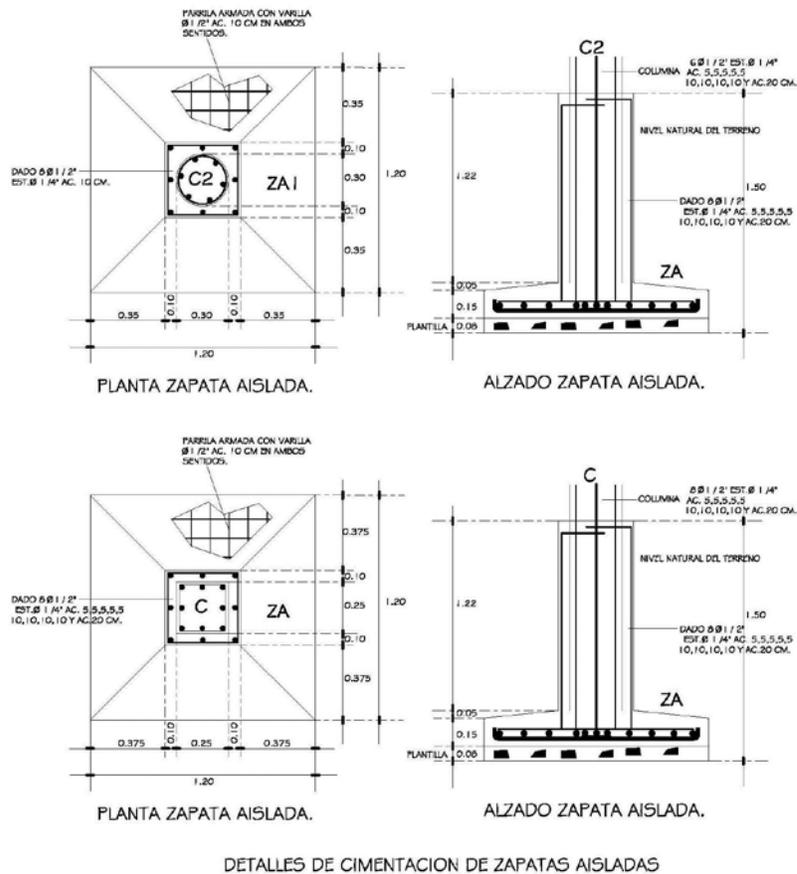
Detalle de cimentación de zapatas aisladas.
